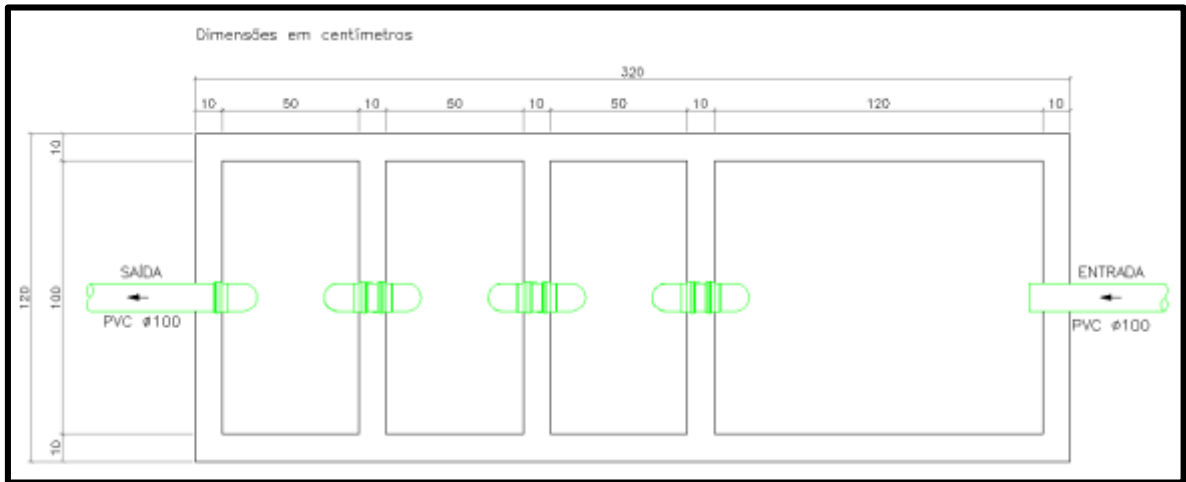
Planta baixa da Caixa separadora de água, óleo e lama.
